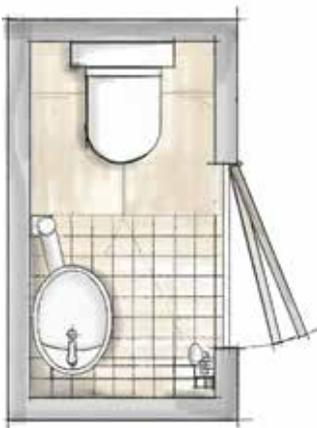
Umbauvariante 3 – Gästetoilette mit Assistenz beim Duschen (Grundriss: DLW)
